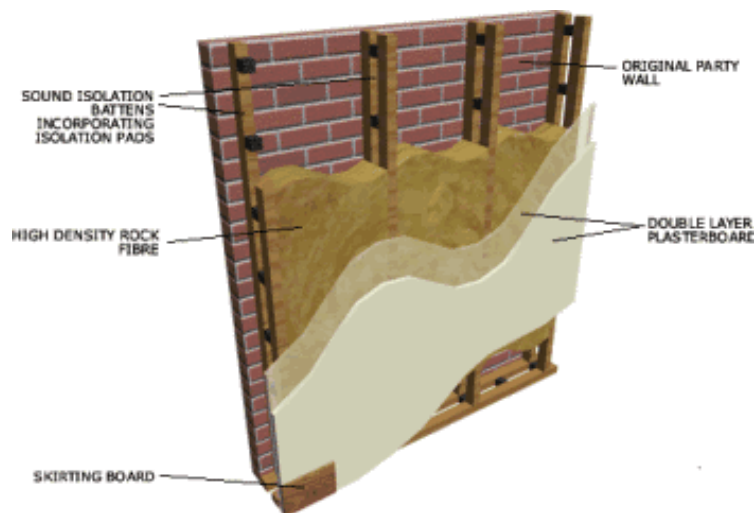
sistema base de aislamiento térmico en muro de ladrillo, con fibra y madera, fuente:<http://www.duiops.net/hifi/images/guiaHT/soundwall1.gif>
